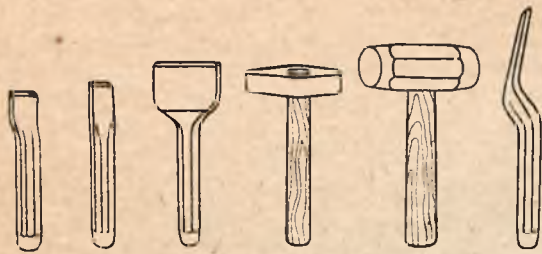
Przygotowanie złącza kielichowego do zalania ołowiem
